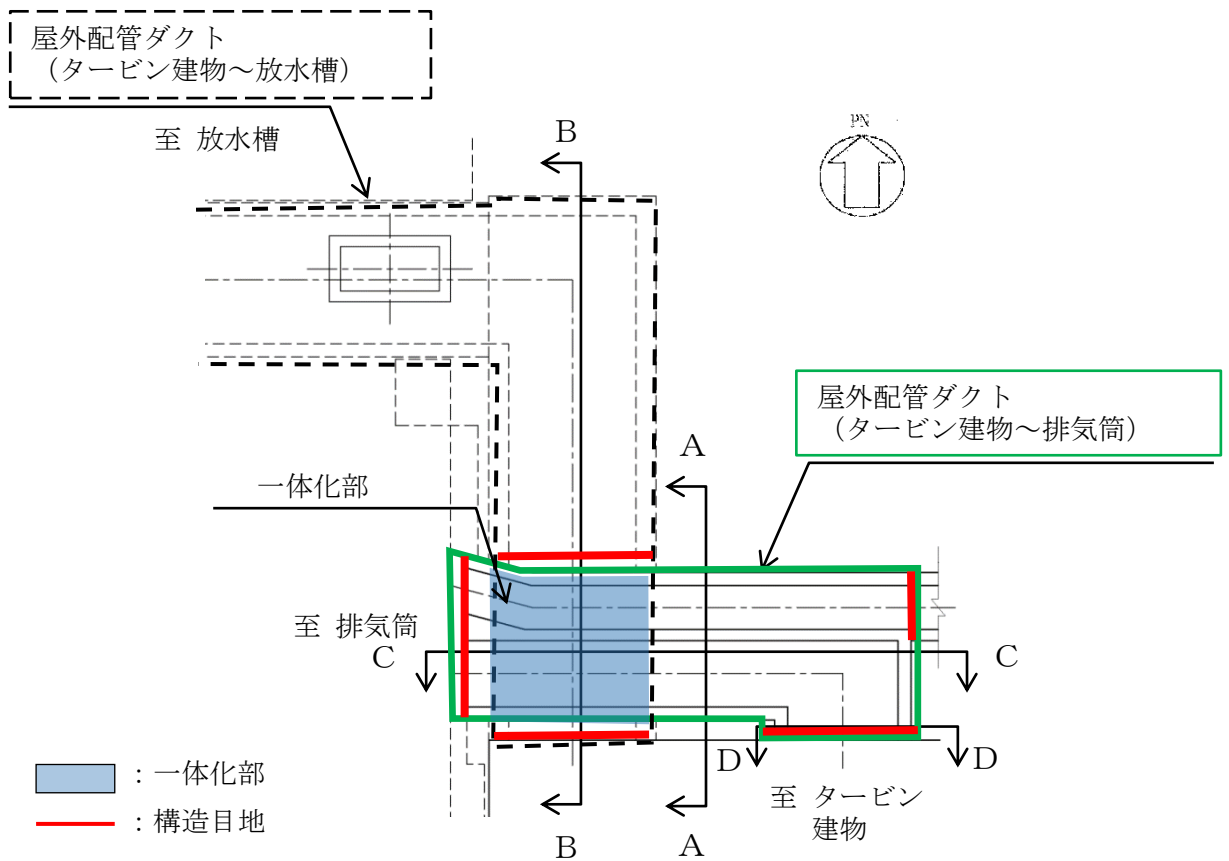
屋外配管ダクト（タービン建物～排気筒） 平面図
